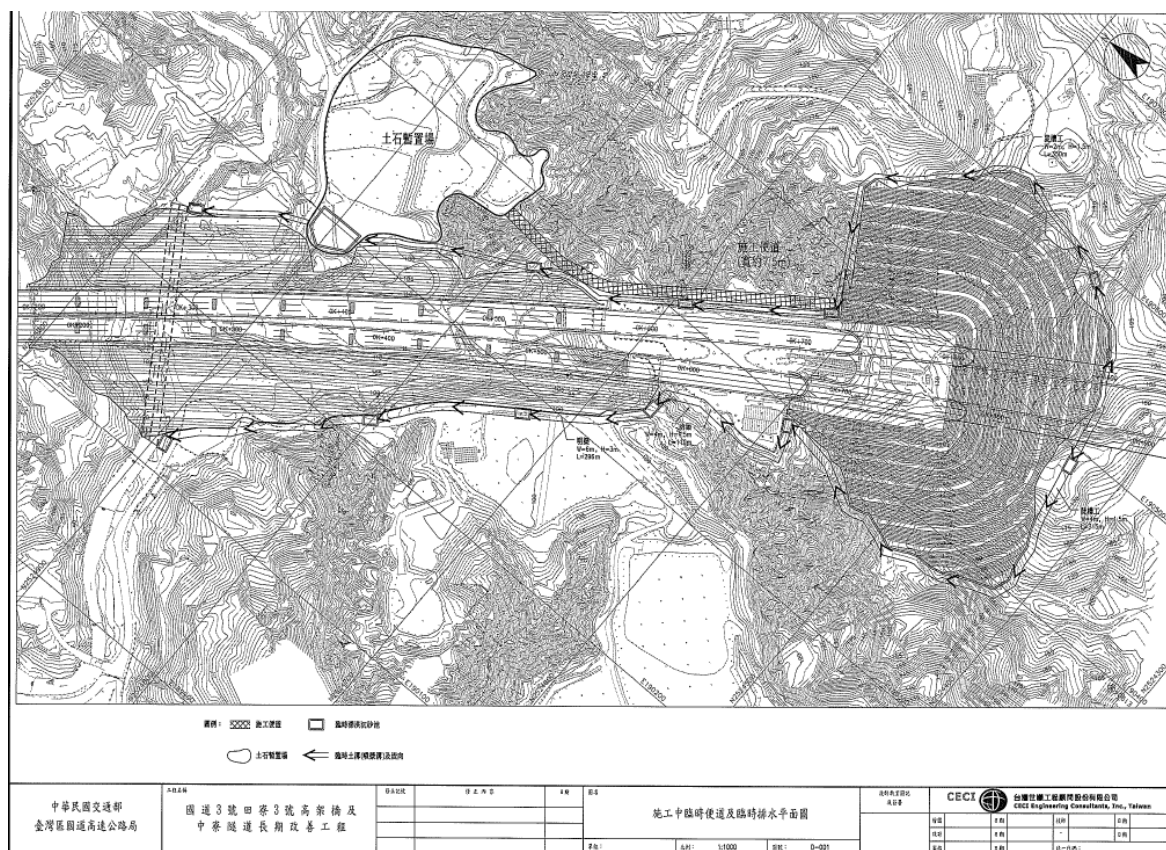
施工臨時便道及土方暫置場平面配置圖
